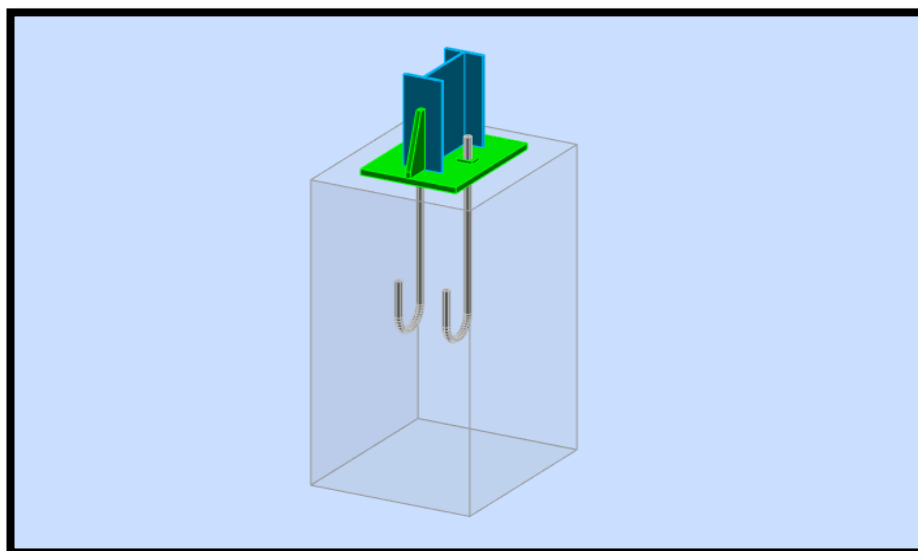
Représentation de l'assemblage pied poteau articulé.
